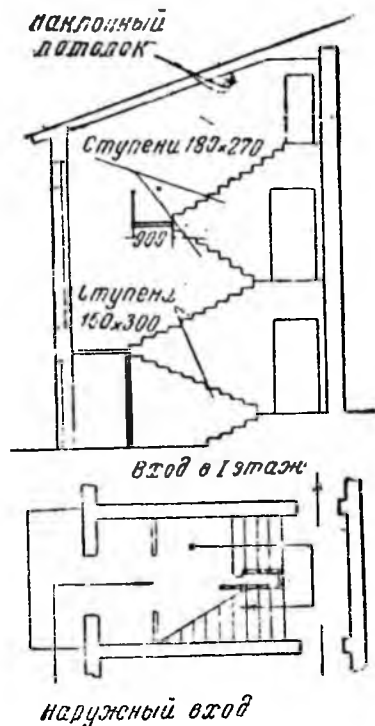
Схема лестницы с наружным выходом и входом на чердак
